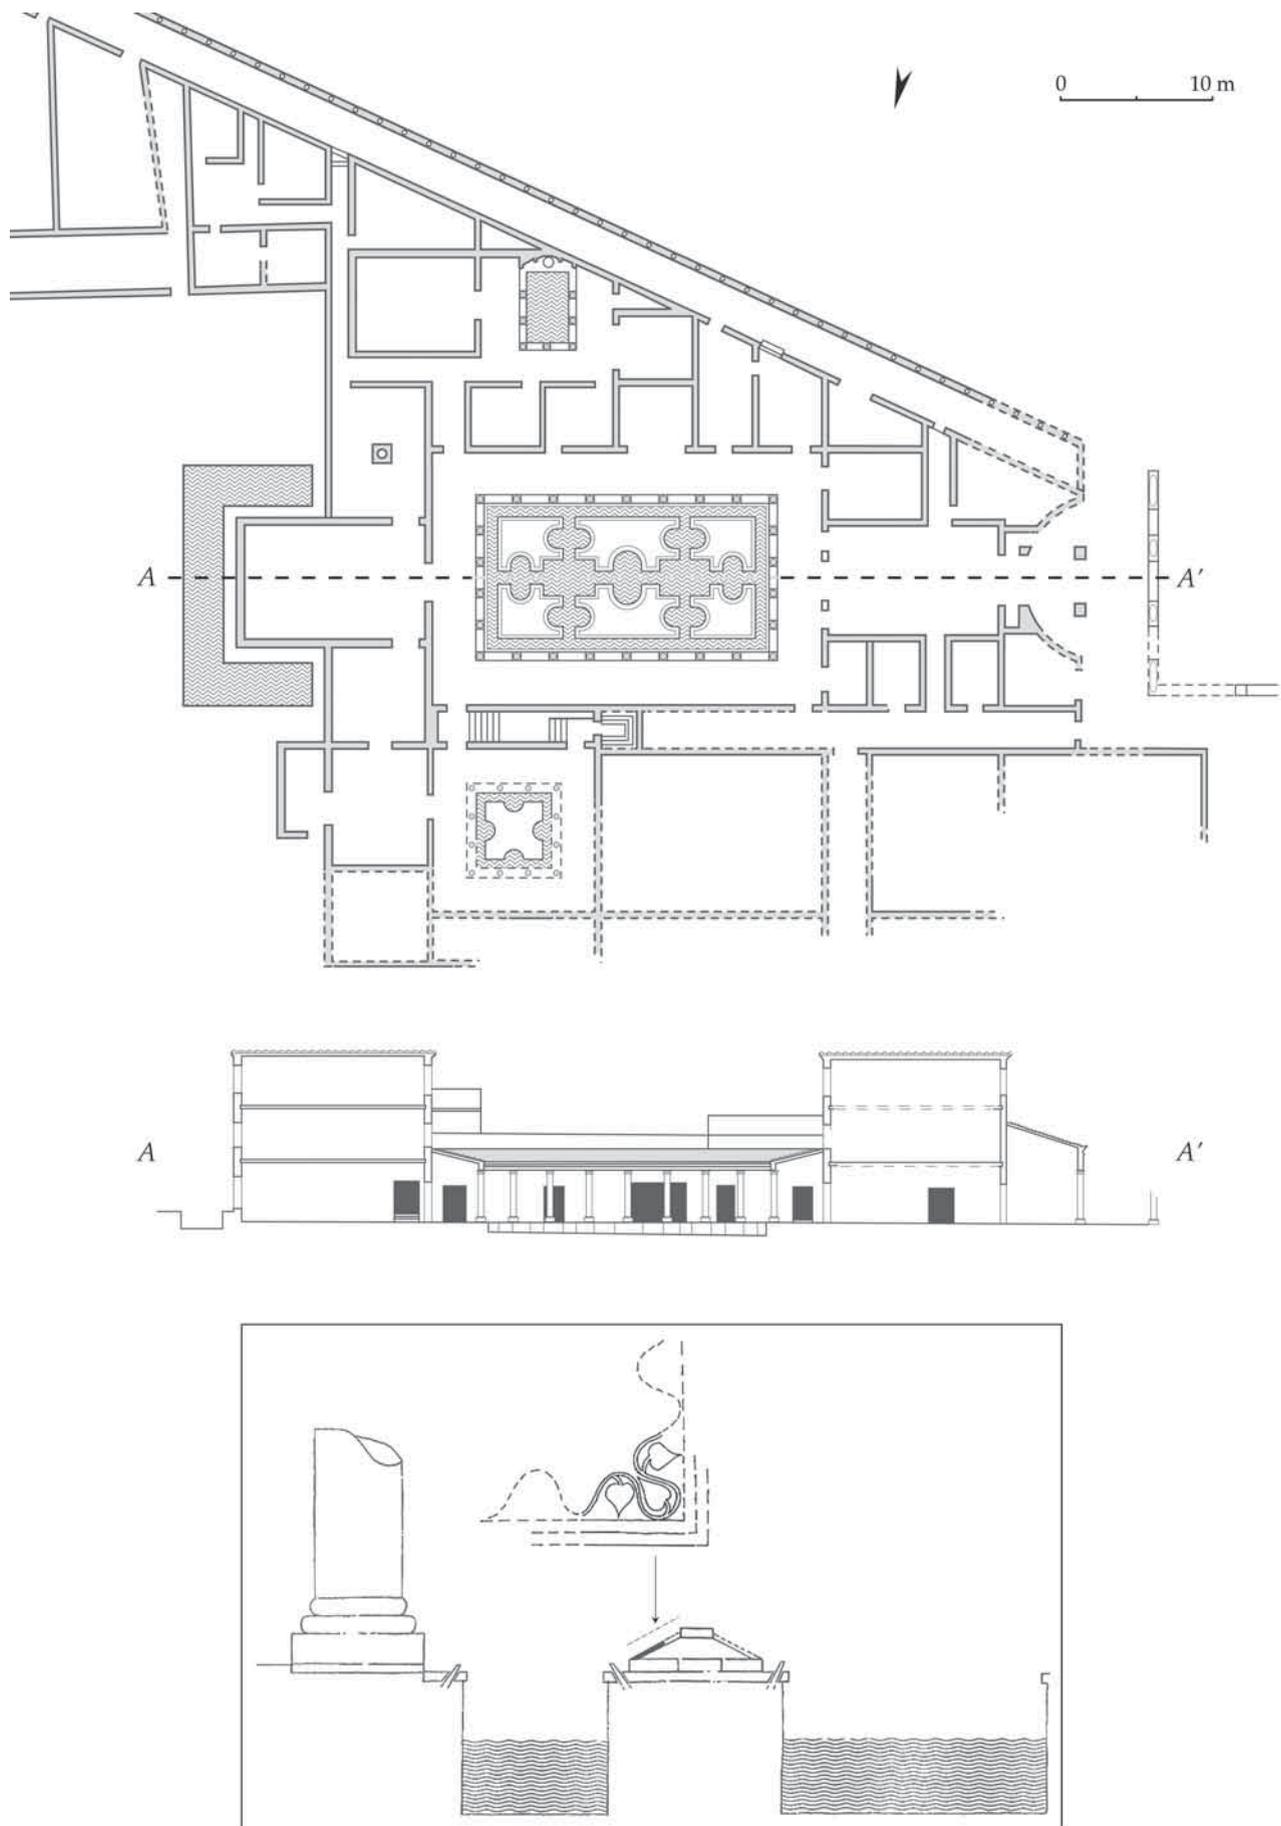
Conimbriga, Maison aux jets d'eau : plan et coupe, avec détail sur le bassin central.
